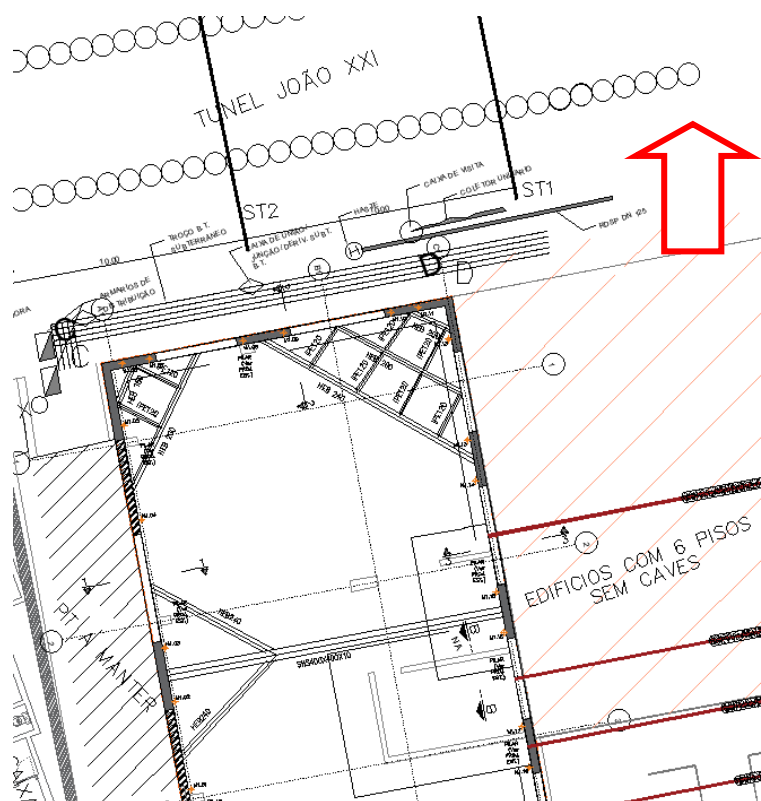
Planta de Escavação e Contenção Periférica – Zona Norte
